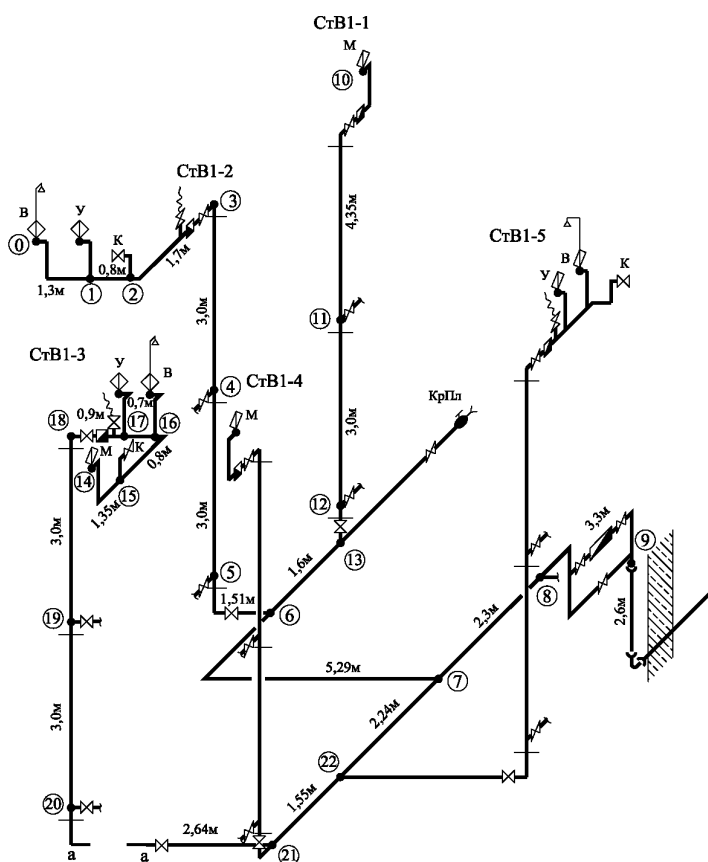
Пример. Схема гидравлического расчета внутреннего водопровода
